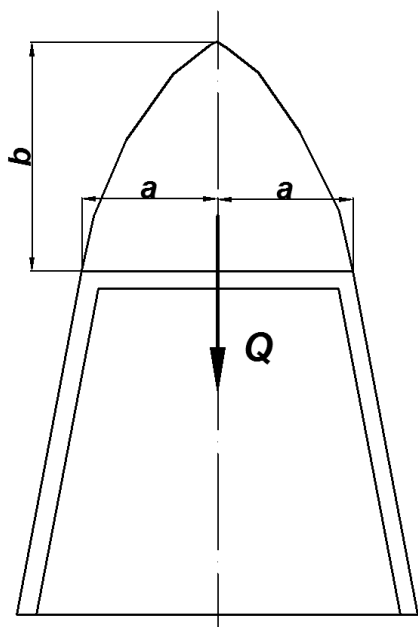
Схемы к расчету нагрузки на крепь при трапециевидной форме выработки
